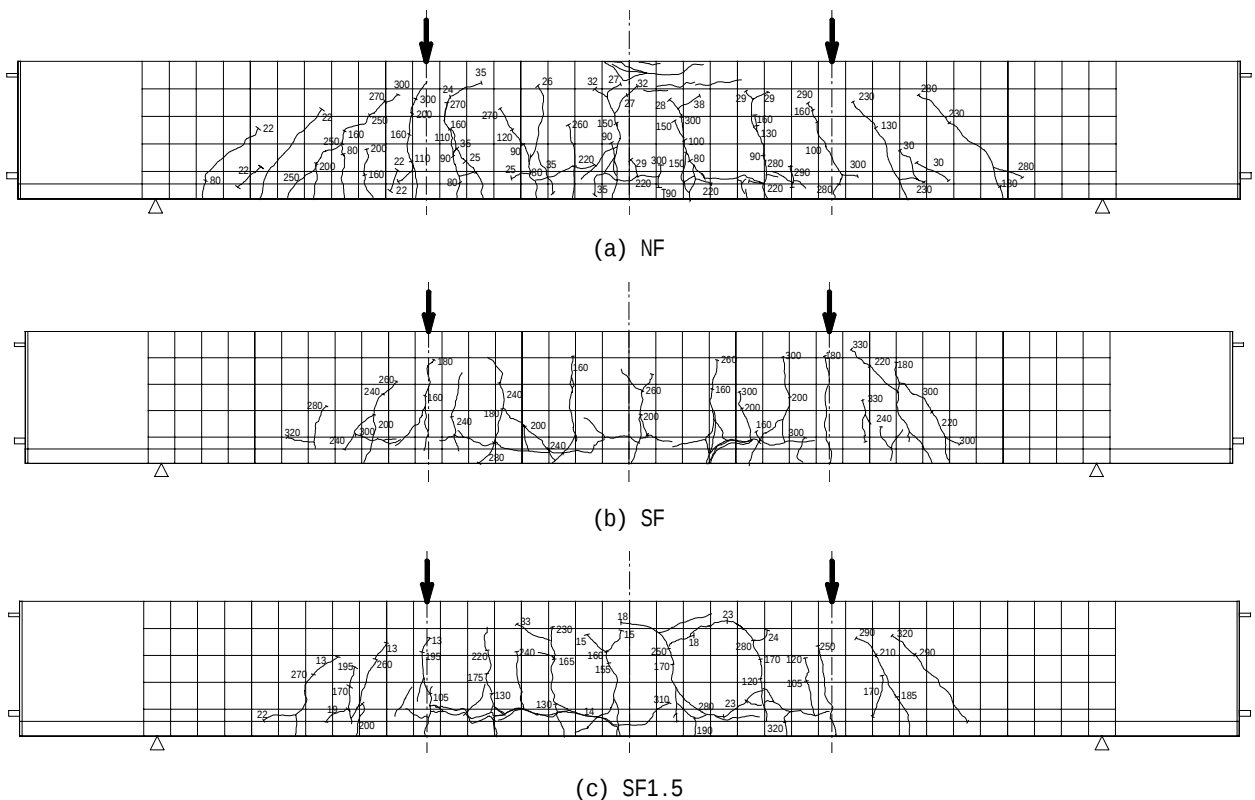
ひび割れ図 - 終局時 (NF，SF，SF1.5)
